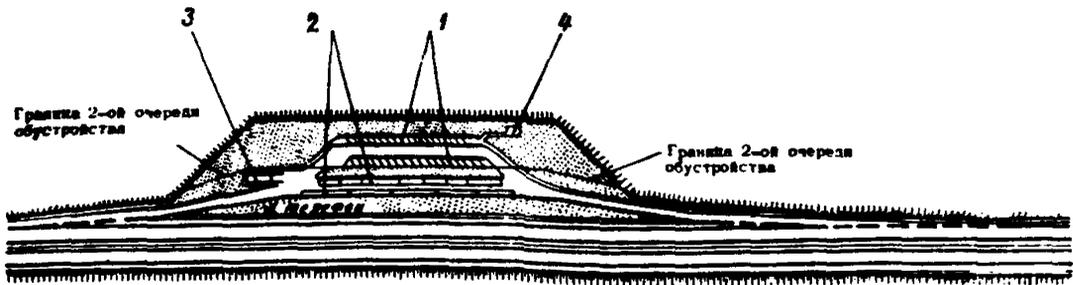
Схема площадки для стоянки на перегоне (французский вариант). Обозначения 1-4 см. рис.1
